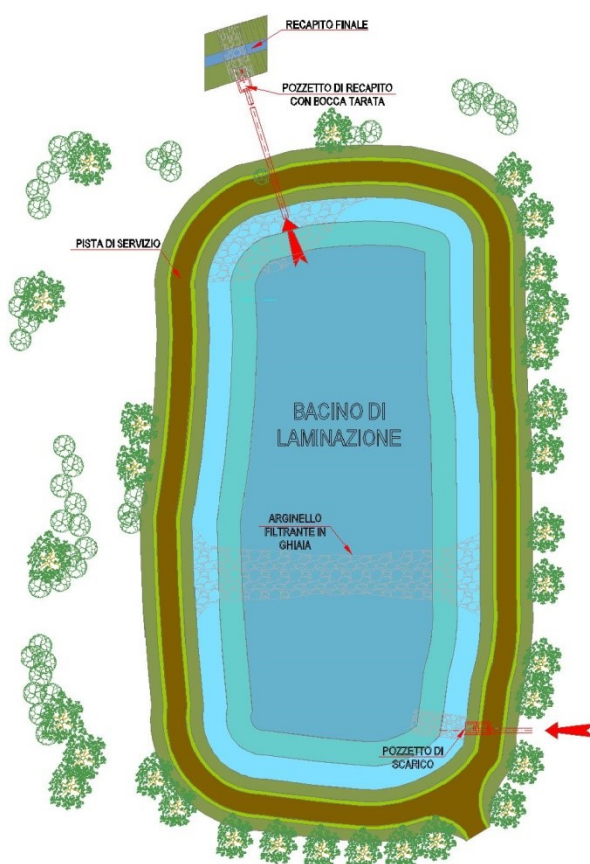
/6.3 – Schema tipo di un bacino di laminazione
